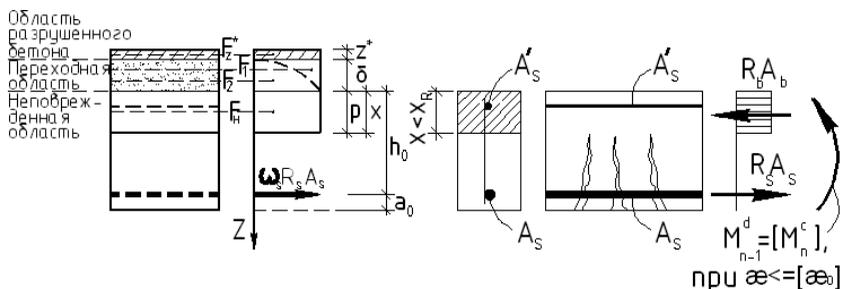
Схема расчетной модели сечения железобетонного элемента балки в запредельном состоянии при пластическом «мягком» случае разрушения
